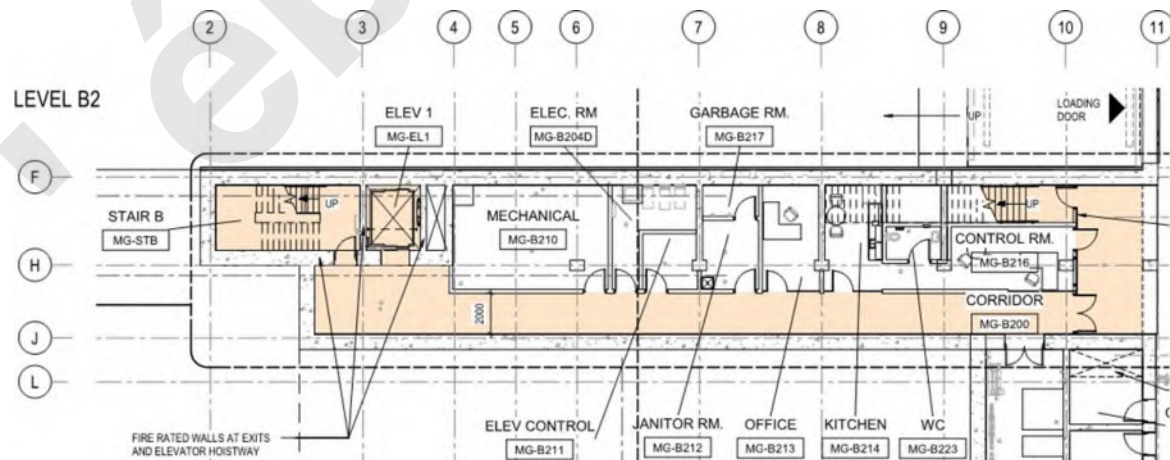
Pavillon de l'énergie – Plan du niveau B2 (au niveau de l'usine)
